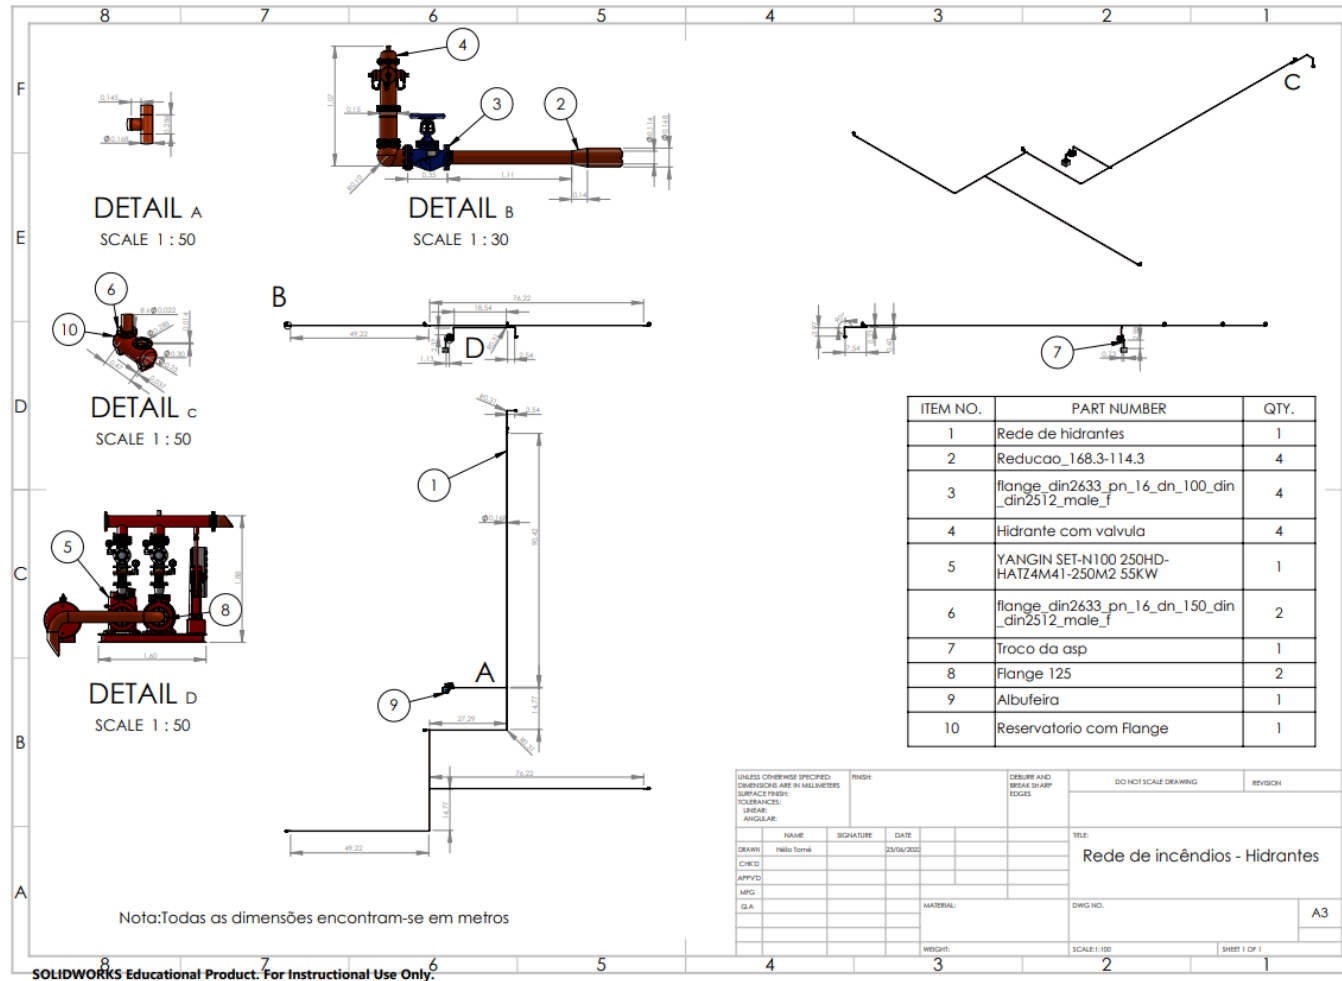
Anexo IV - Desenho técnico cotas RIA
